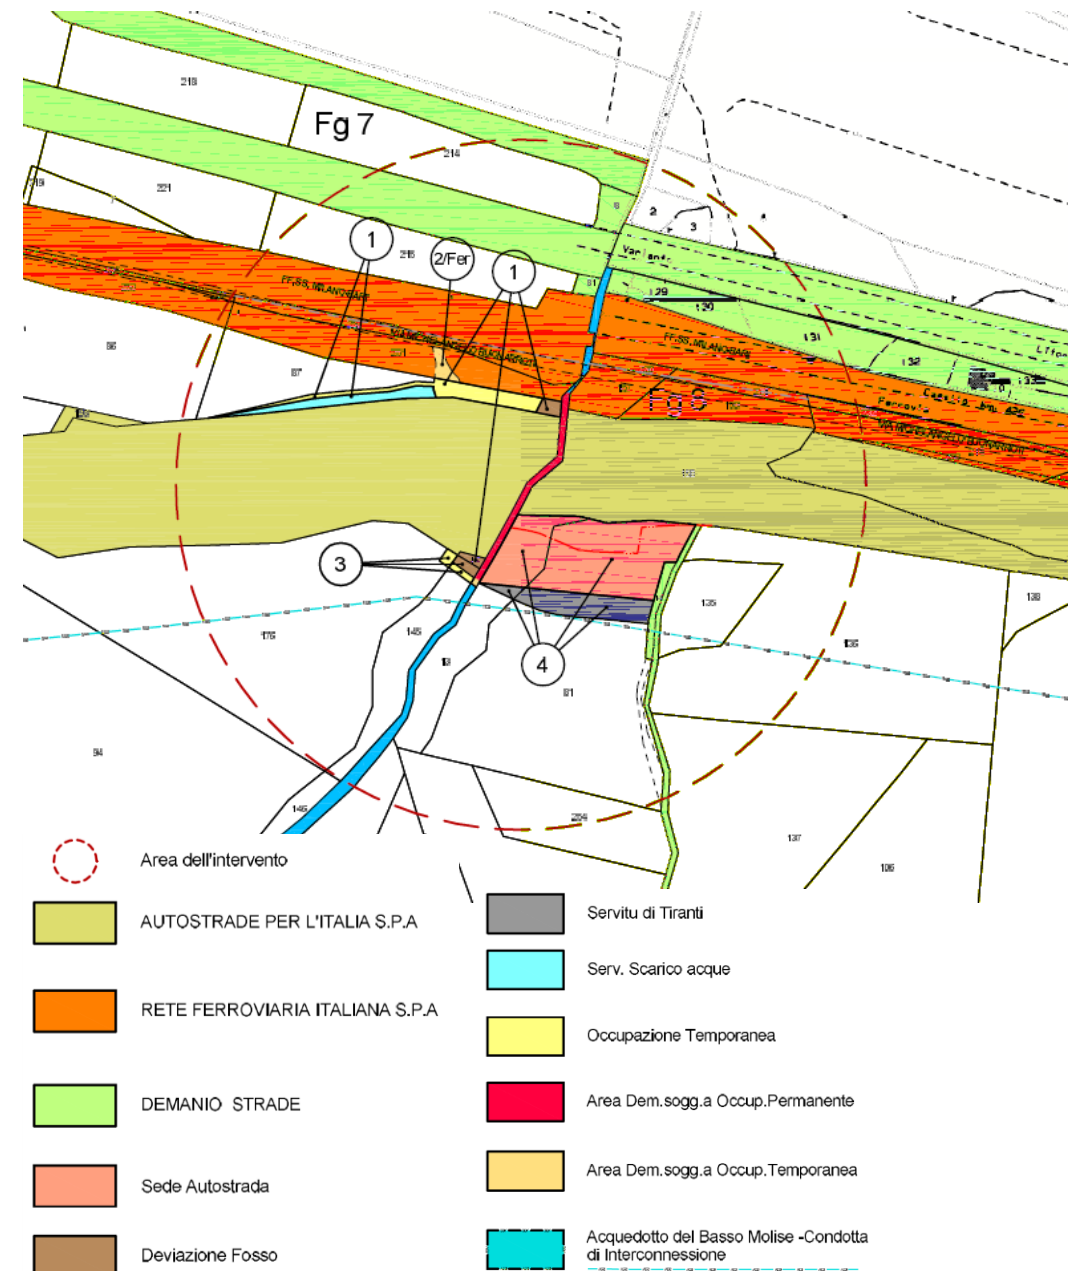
Planimetria aree interessate dall'intervento su base catastale
